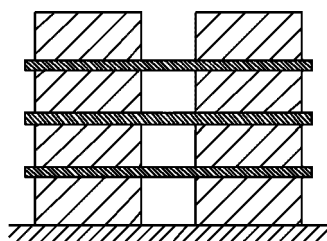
Sistemas estruturais mistos. Tipo 3 – paredes mistas ou de betão acopladas por vigas de aço ou mistas
